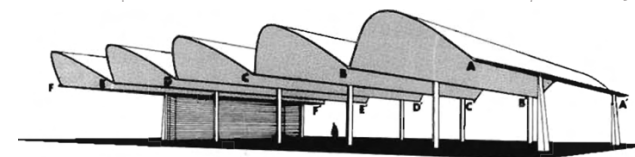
| Perspectiva y sección de bóveda autoportante. Fuente: Consejería de Arquitectura y Vivienda
